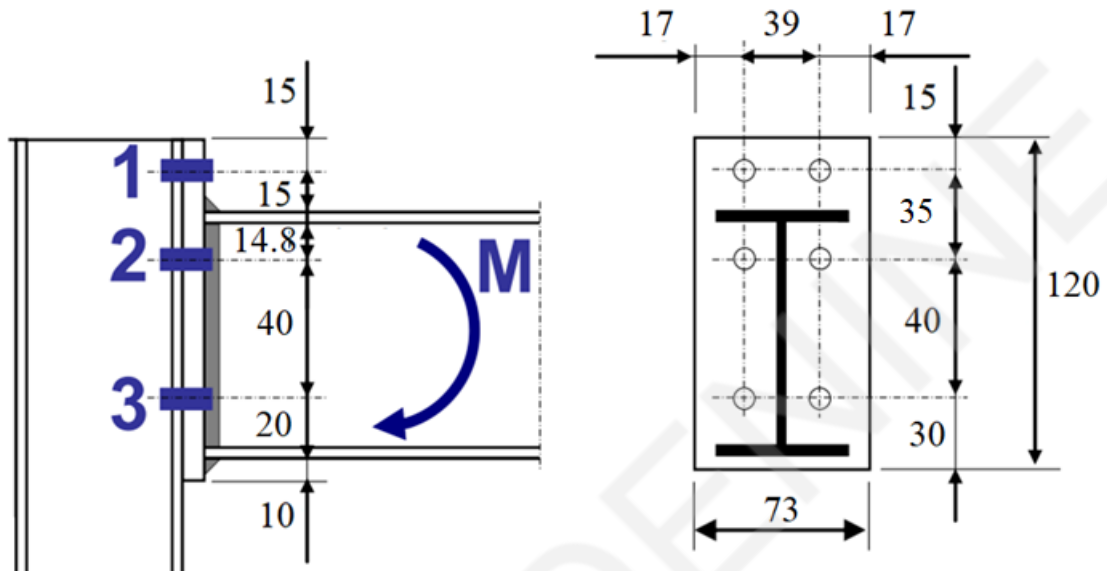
Configuration d'assemblage poteau-traverse (4)
